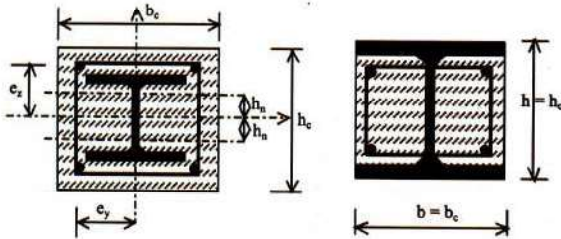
Exemple des sections transversales des poteaux partiellement ou totalement enrobés de béton.
